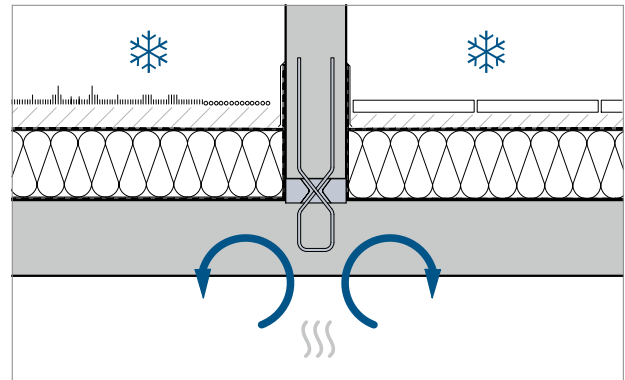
Pos ③: Wärmefluss bei Dachaufbau mit Schöck Sconnex® Typ W
